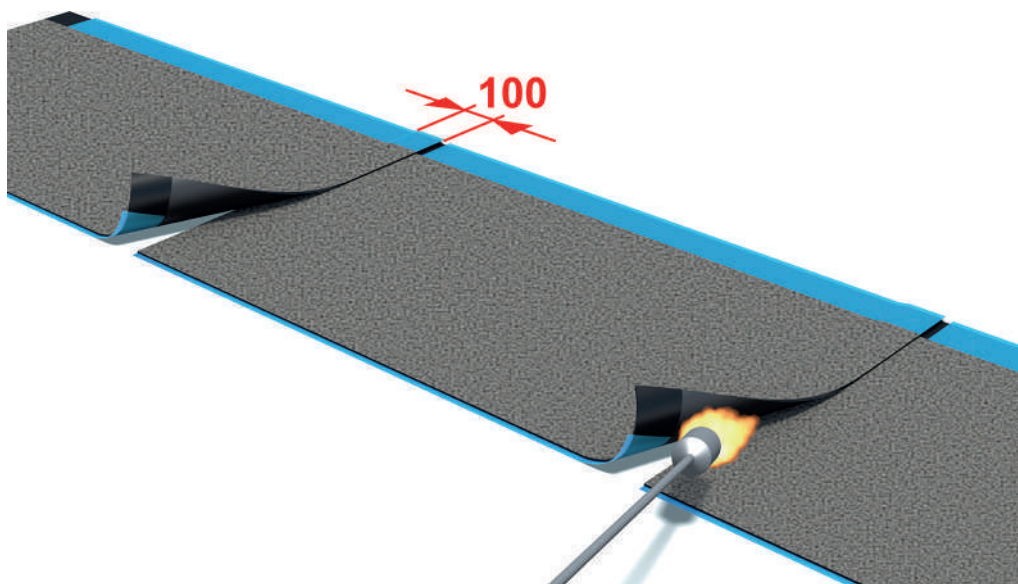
Сварка торцевых швов УЛЬТРАНАП
